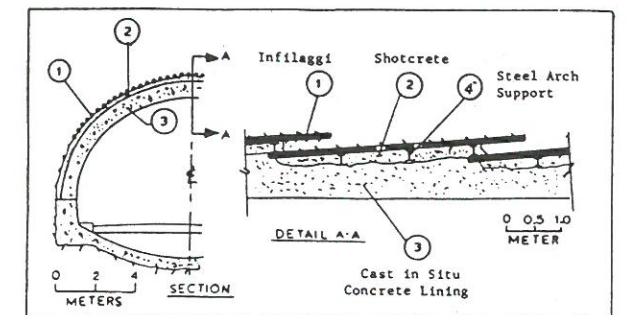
Sezione della galleria e particolare degli infilaggi di sostegno
